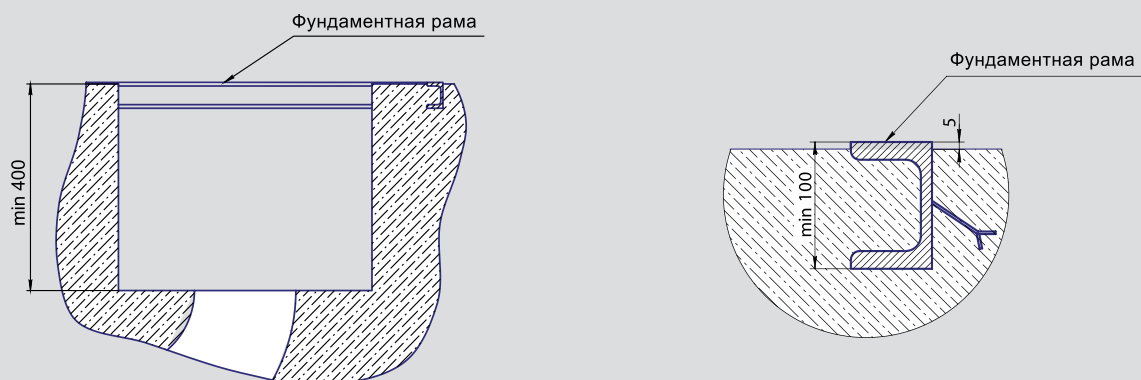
Пример конструкции фундаментной рамы и кабельного приемка
